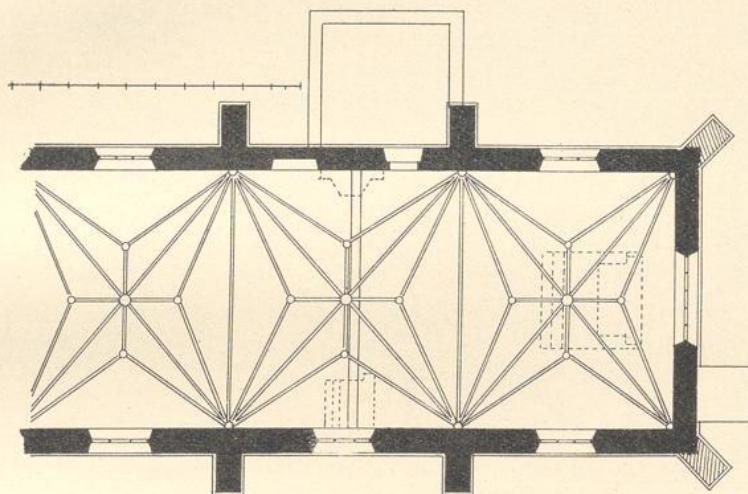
Ehemalige Kommende Lage; Kirche, Grundriß des älteren Teiles (1:250).
